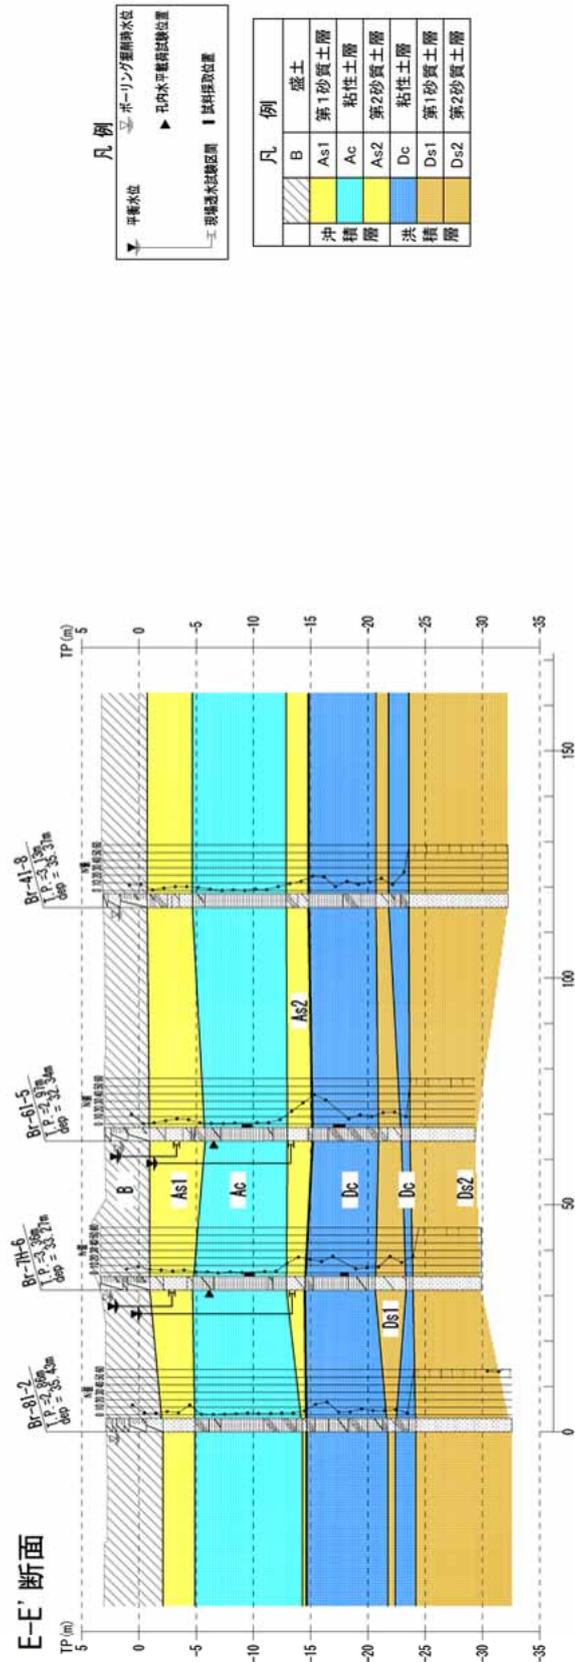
(3) 地質推定断面図 (E-E'断面)
